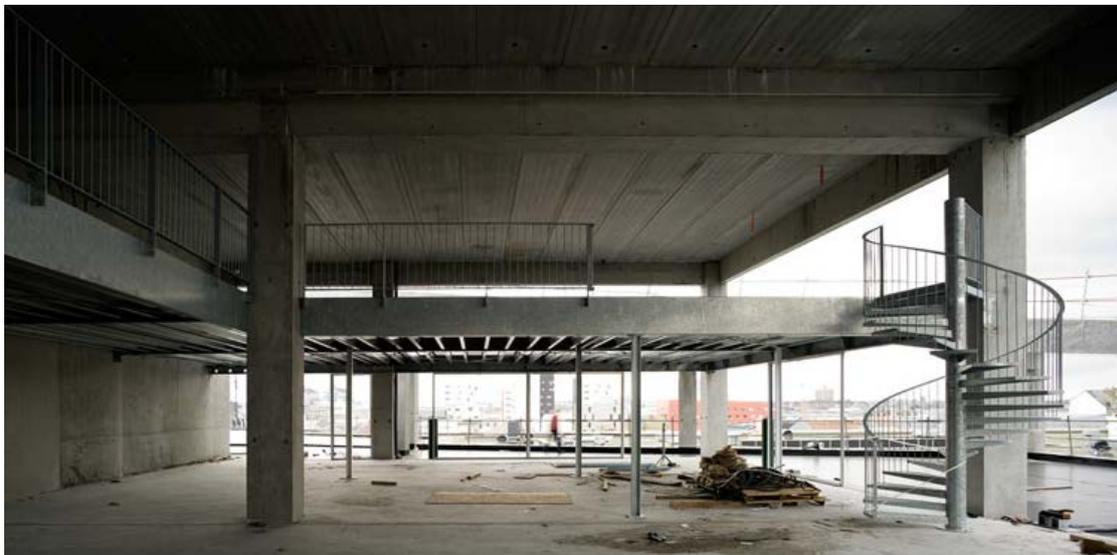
Construção da estrutura secundária no interior da primária. Fonte: Lacaton e Vassal.
